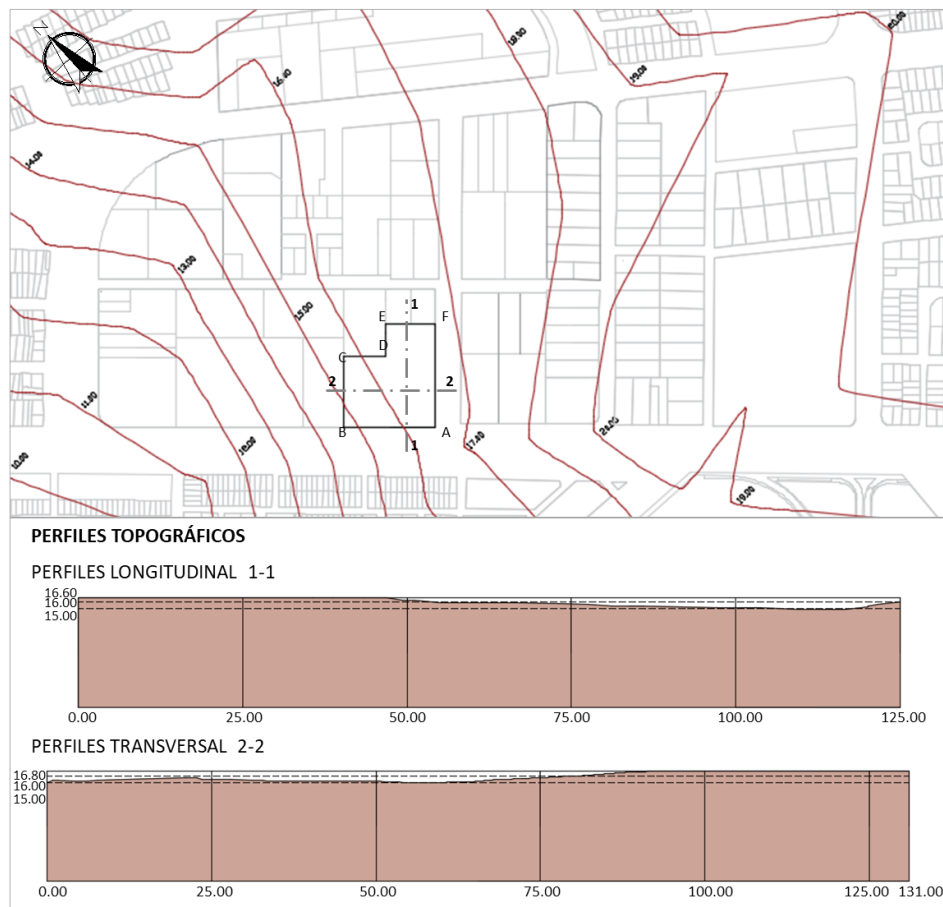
Plano topográfico del terreno. Fuente: Elaboración propia.
